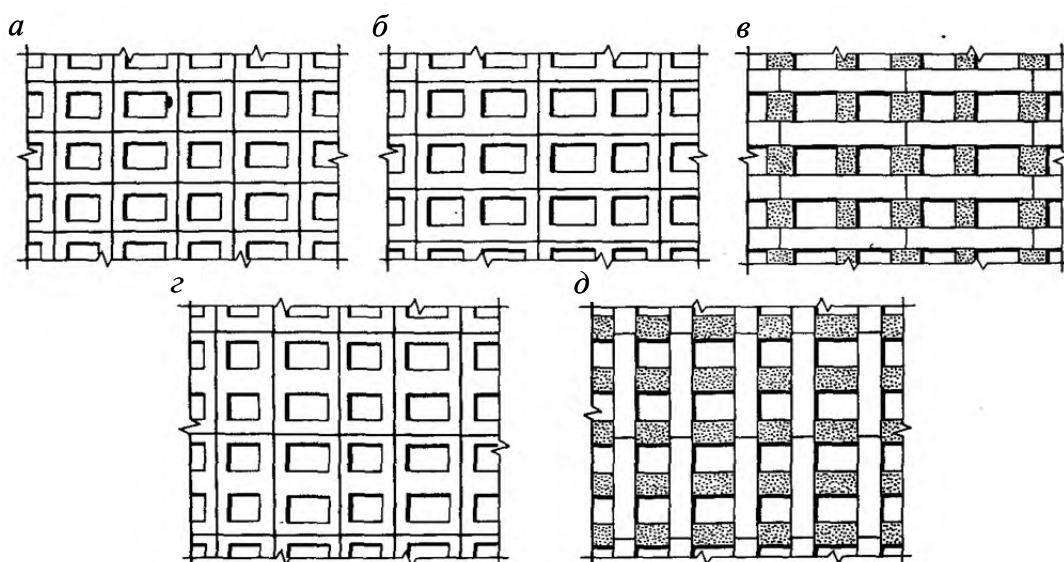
Схемы разрезки наружных стен на панели:
